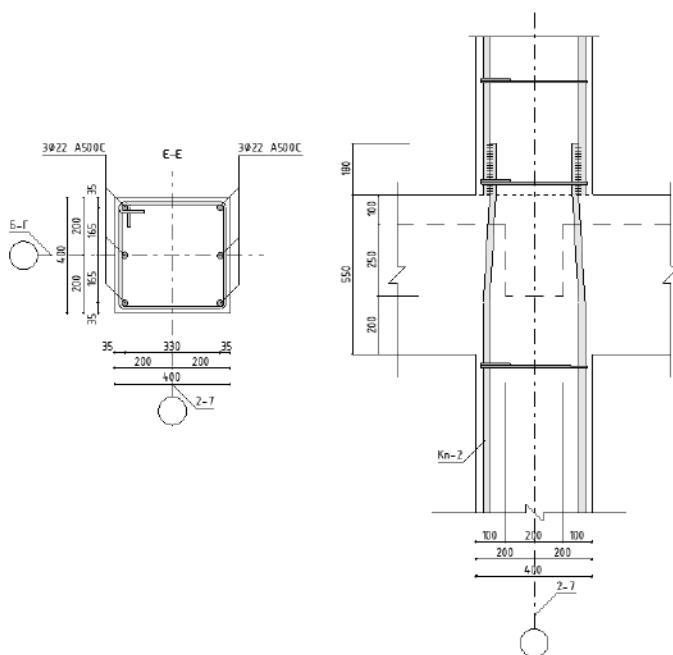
Переріз колони та вузол стикування колон між поверхами
